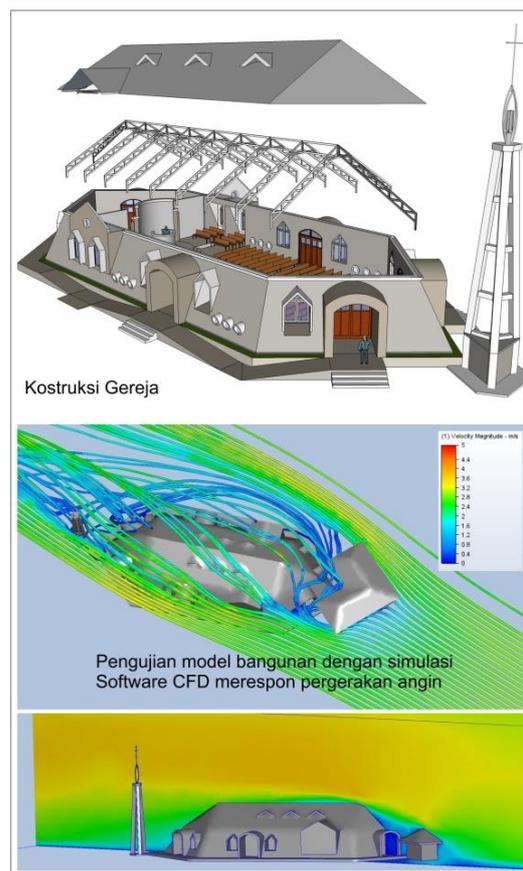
Konstruksi Bangunan Ammu rukoko
